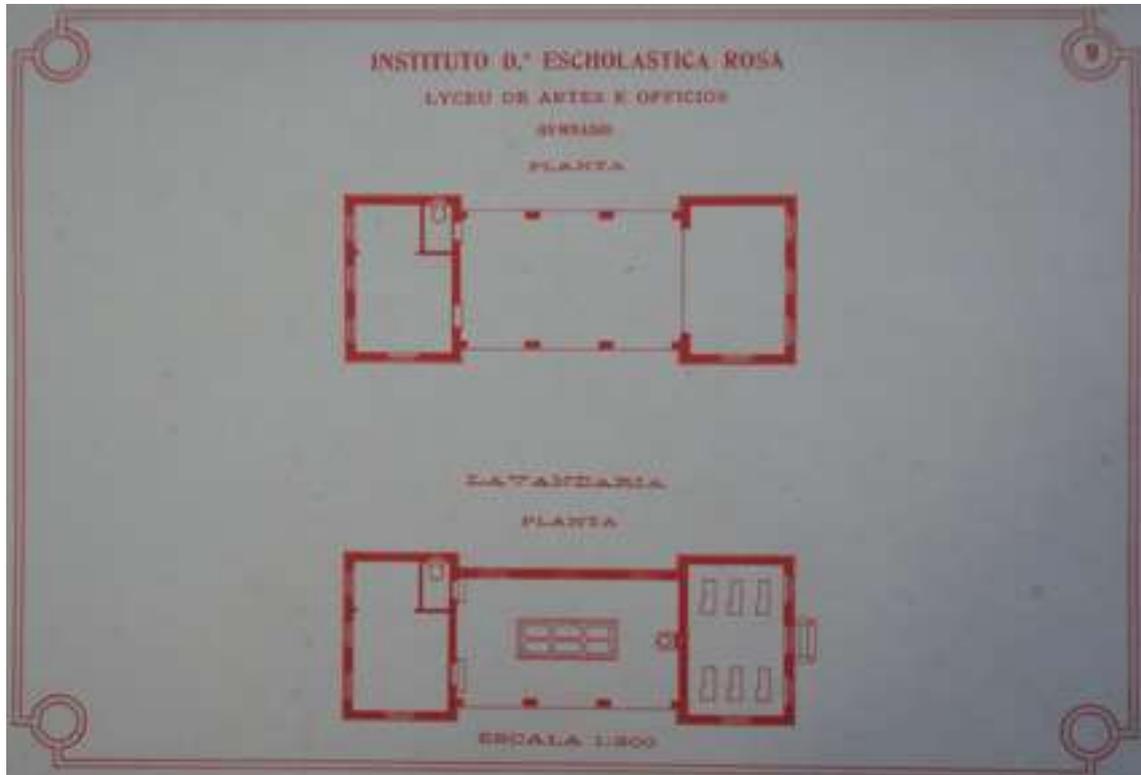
Planta 9 - Ginásio e Lavanderia. Fonte: Conceição (1908)
